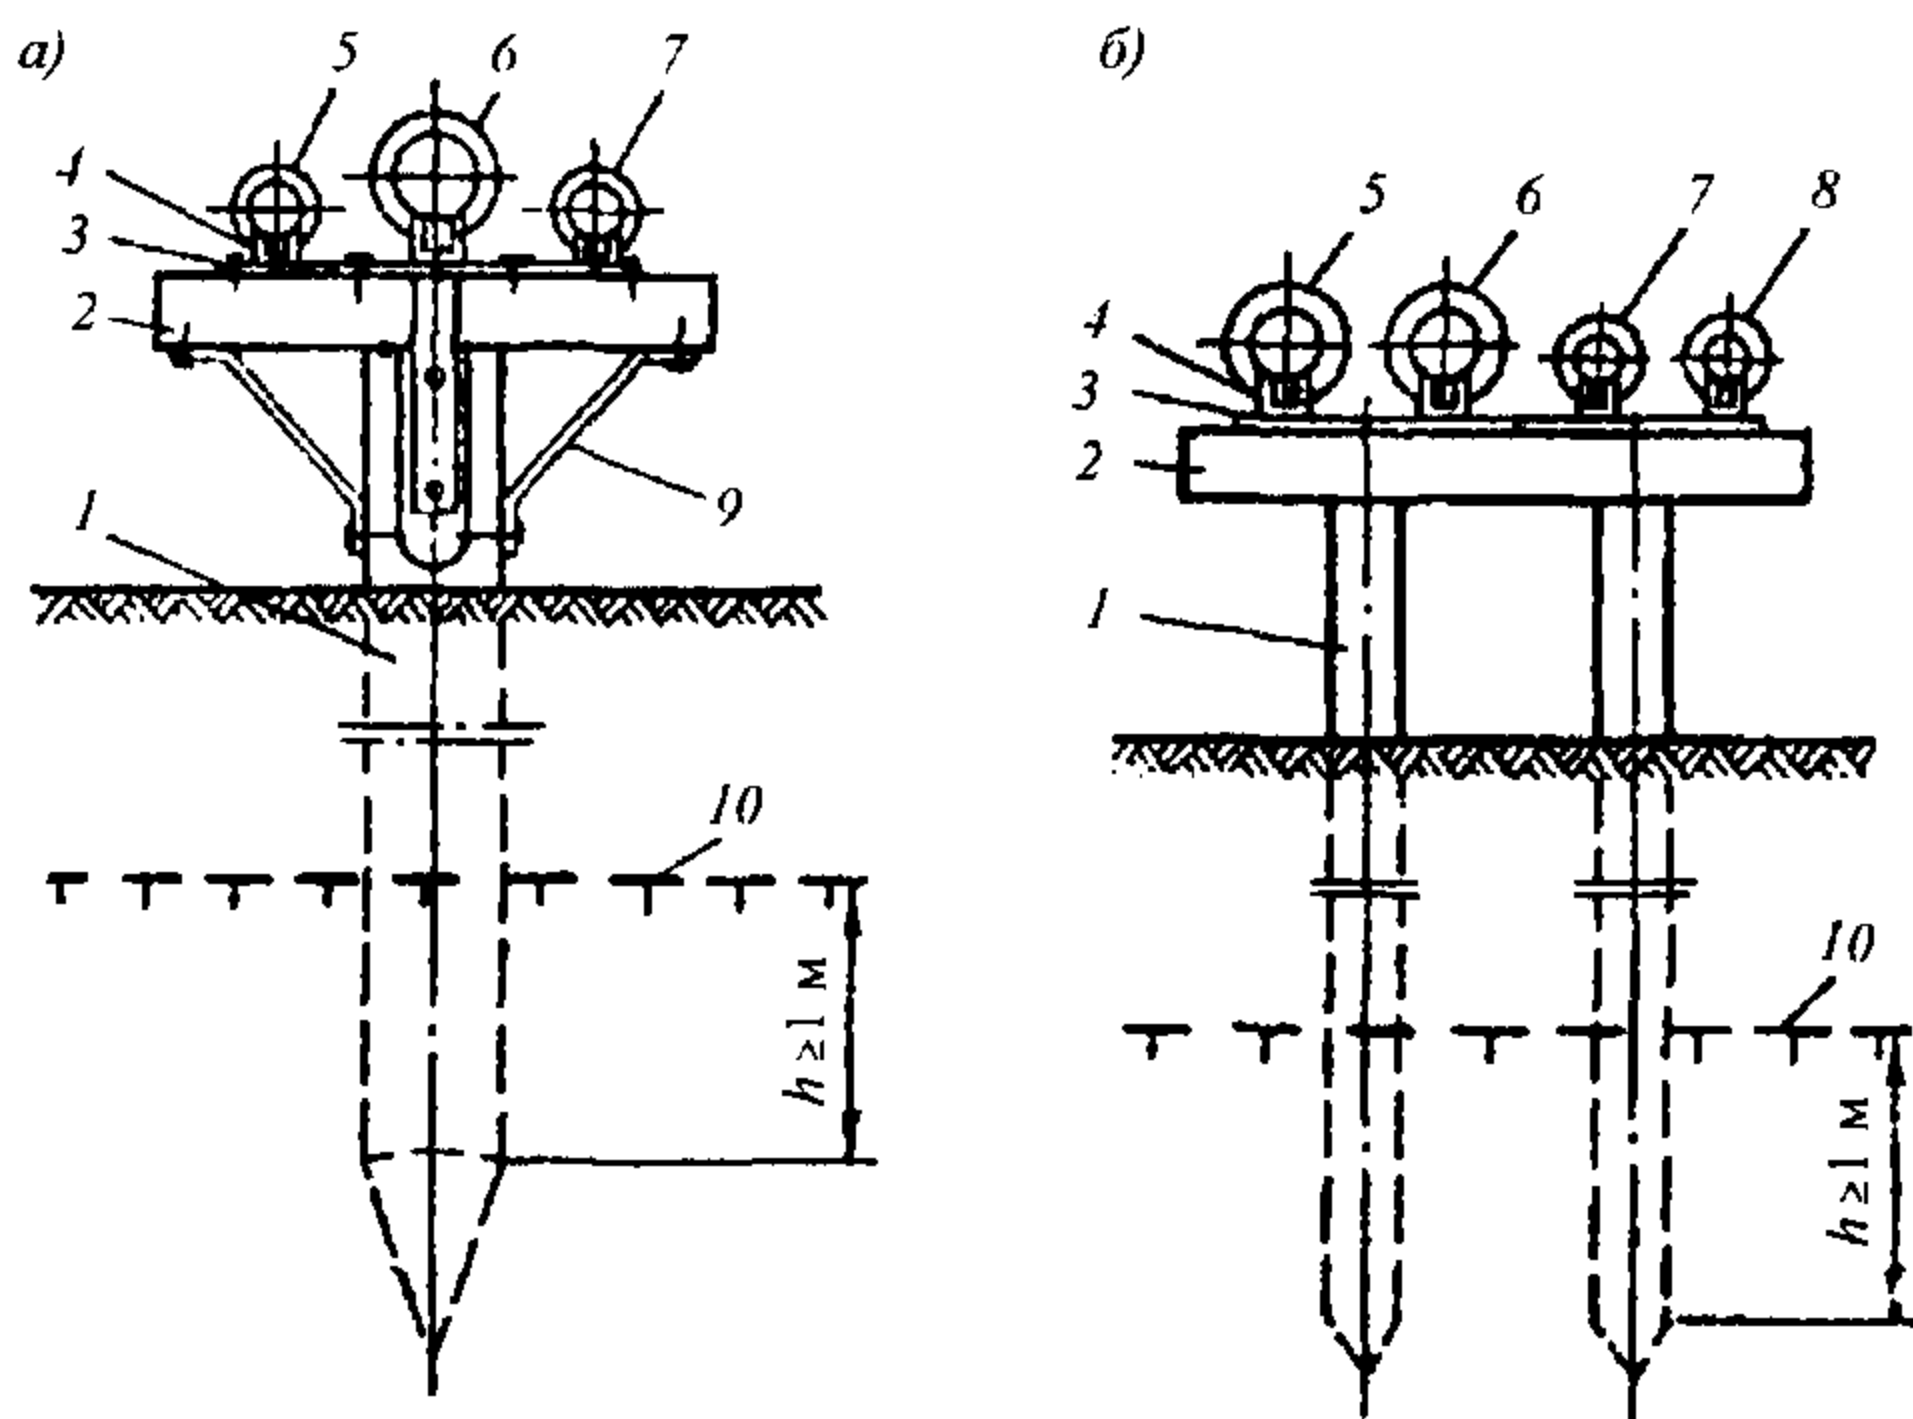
Надземная совмещенная прокладка трубопроводов на свайных опорах: а – деревянная свайная опора; б – железобетонная свайная опора; 1 – свая; 2 – ригель; 3 – металлическая пластина; 4 – скользящая опора; 5...8 – трубопроводы различного назначения; 9 – подкос; 10 – верхняя граница вечномёрзлых грунтов
